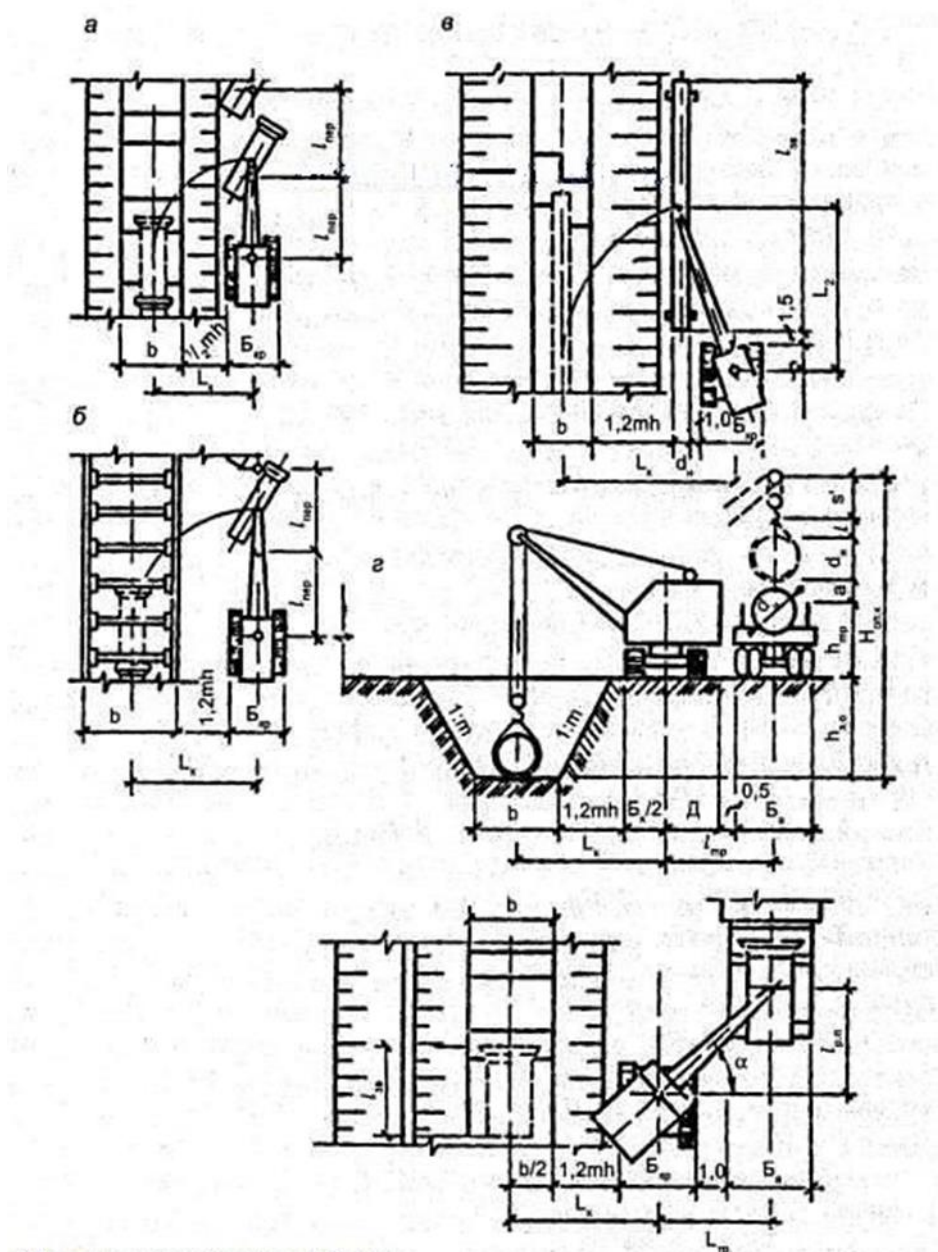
Схема определения рабочих параметров крана при прокладке труб
